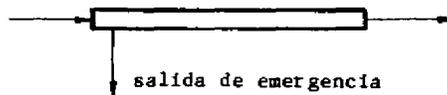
19: Regulador construido como sección de reserva en la alcantarilla
